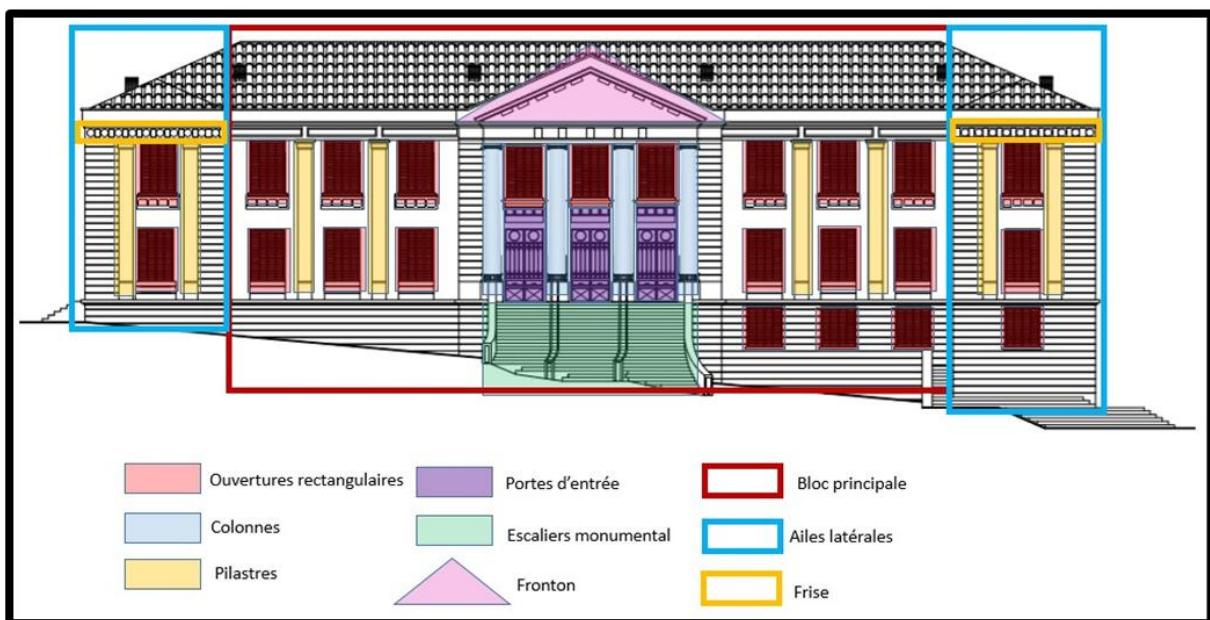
Façade principale (Fond : façade de la direction de l'urbanisme. Traitement : auteur 2025.).
